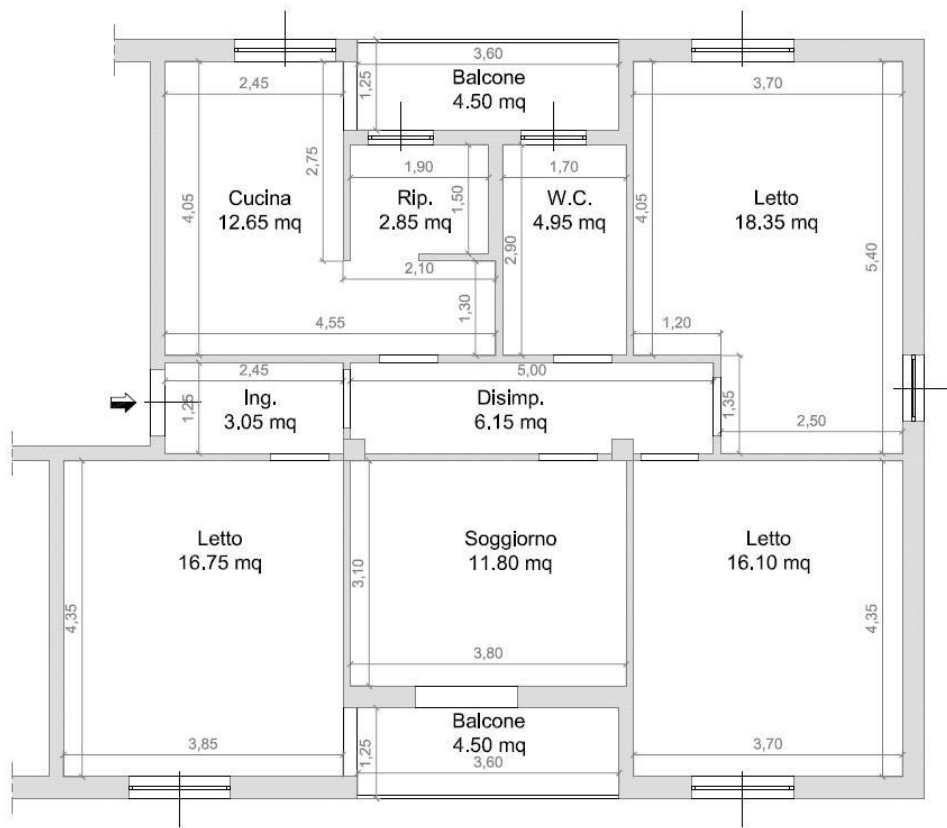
Planimetria Catastale Foglio 29, p.lla 748, sub 45.
